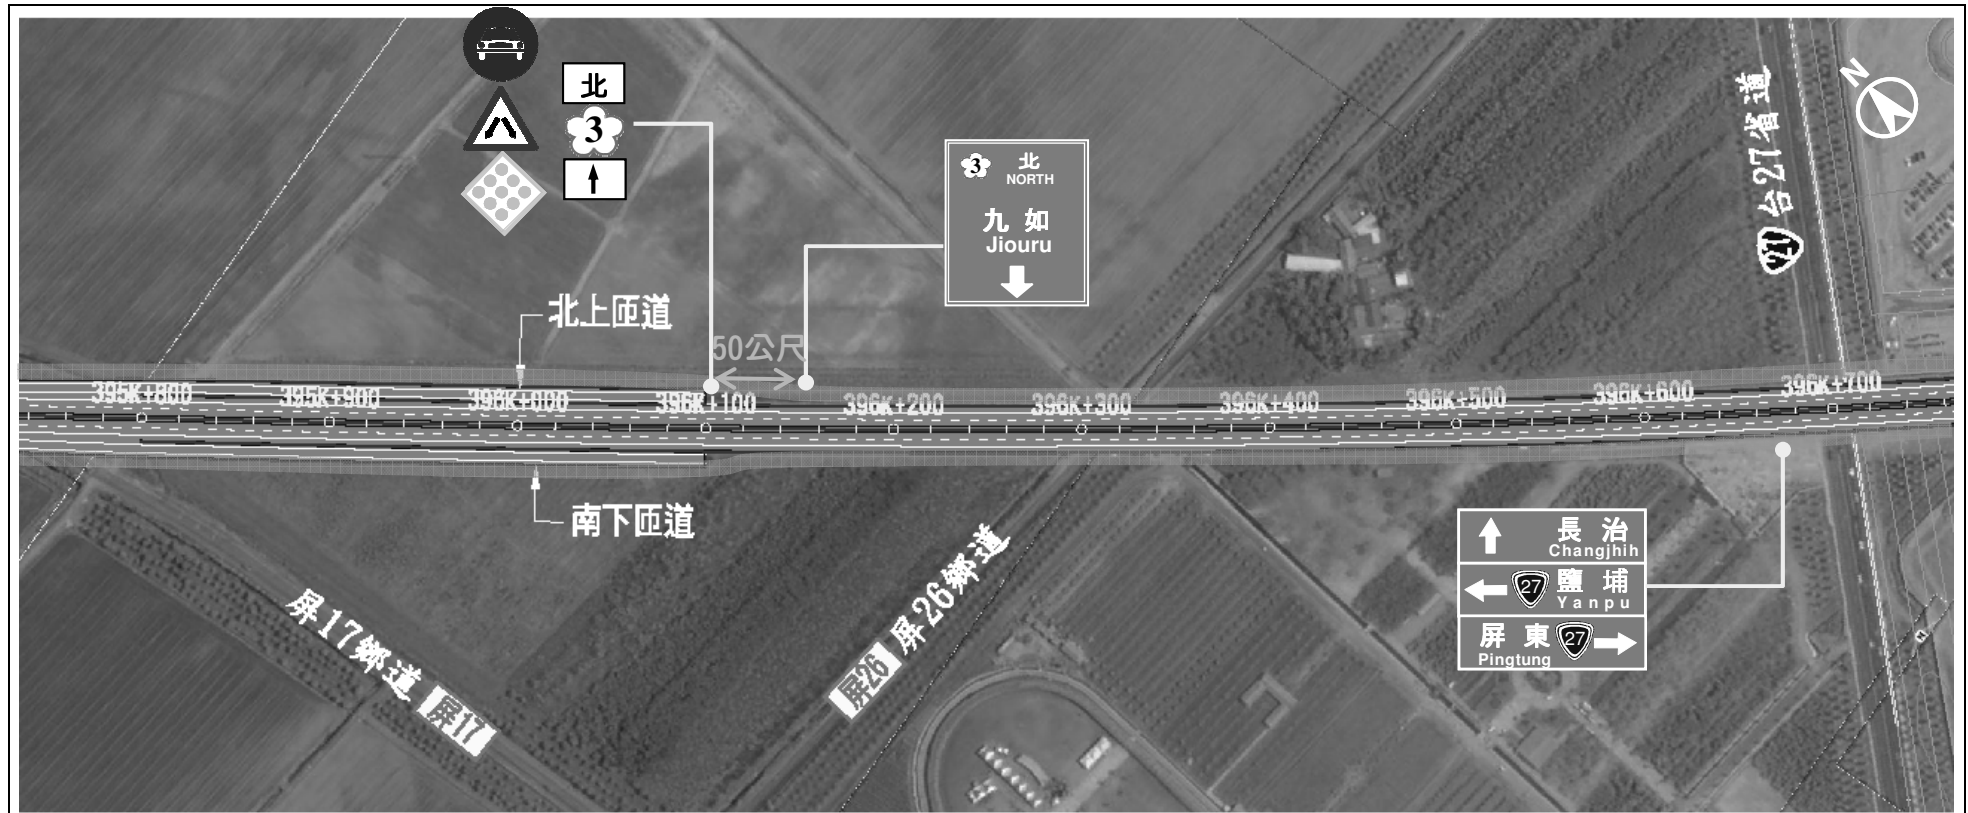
本計畫(北向)匝道銜接國道 3 號橋下平面道路平面圖
